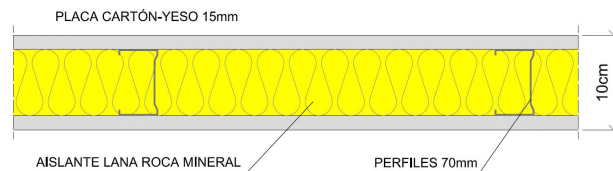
Detalle de la sección horizontal, distribución entre aulas-pasillos.
